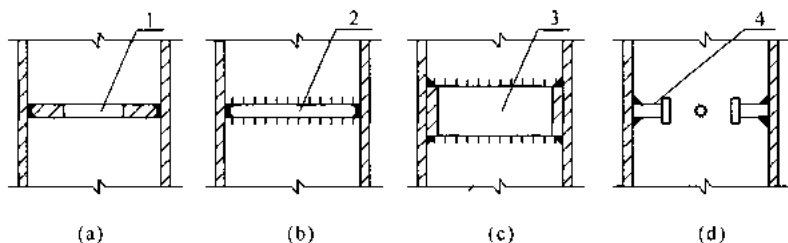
焊接于钢管内壁的抗剪连接件
